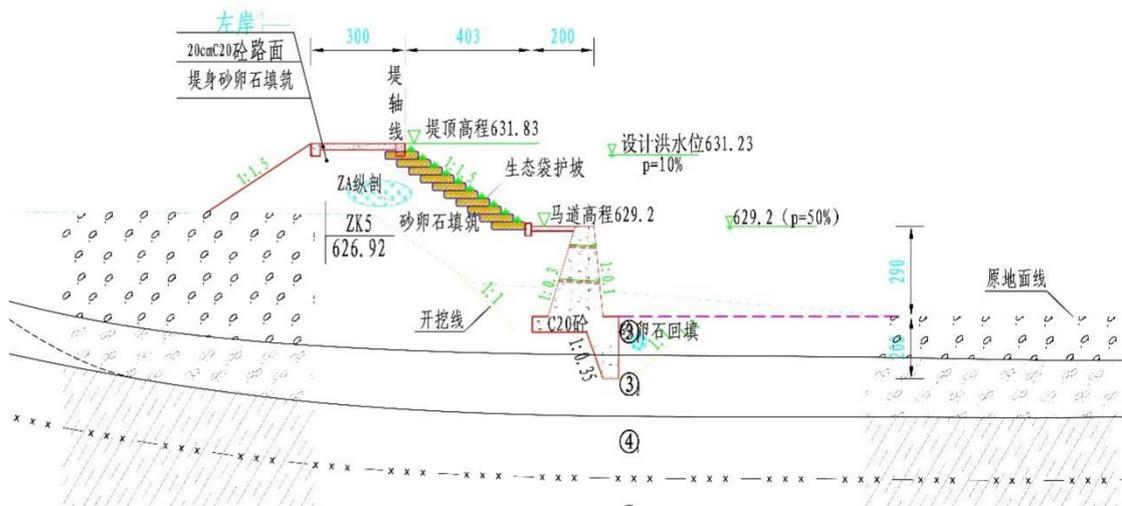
重力式挡墙基础+生态护坡堤型断面图
